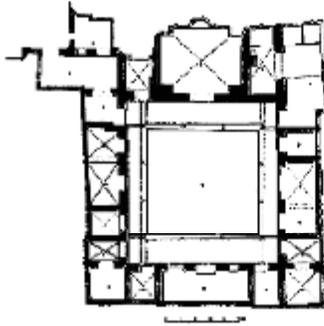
مسقط أفقي لجامع القيروان، عن: أحمد فكري؛ المسجد الجامع بالقيروان، شكل 2
